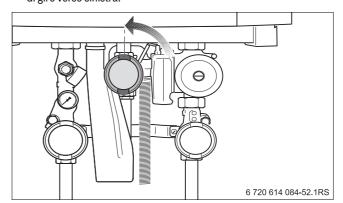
Aprire il rubinetto del gas (qui con il gruppo di collegamento)
